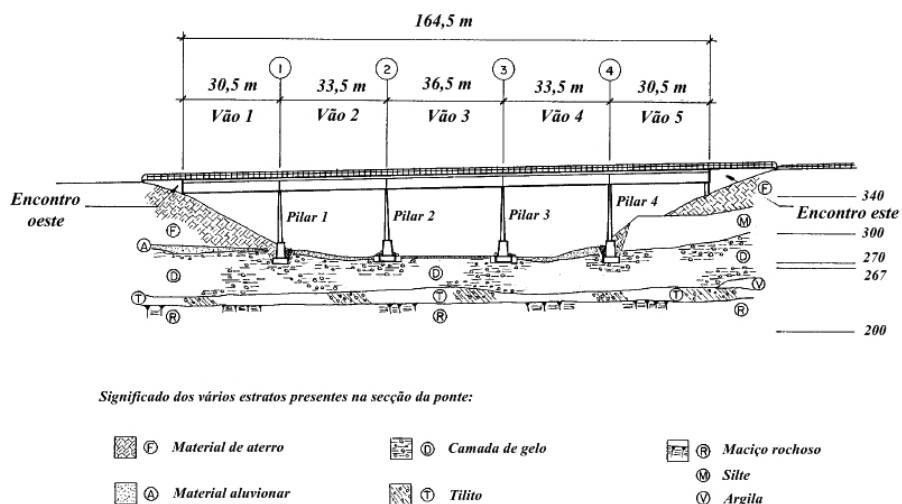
Esquema da estrutura da ponte e do perfil geológico do local de implantação. Vista de sul ou de montante (adaptado de LAGASSE ET AL. 2001).
